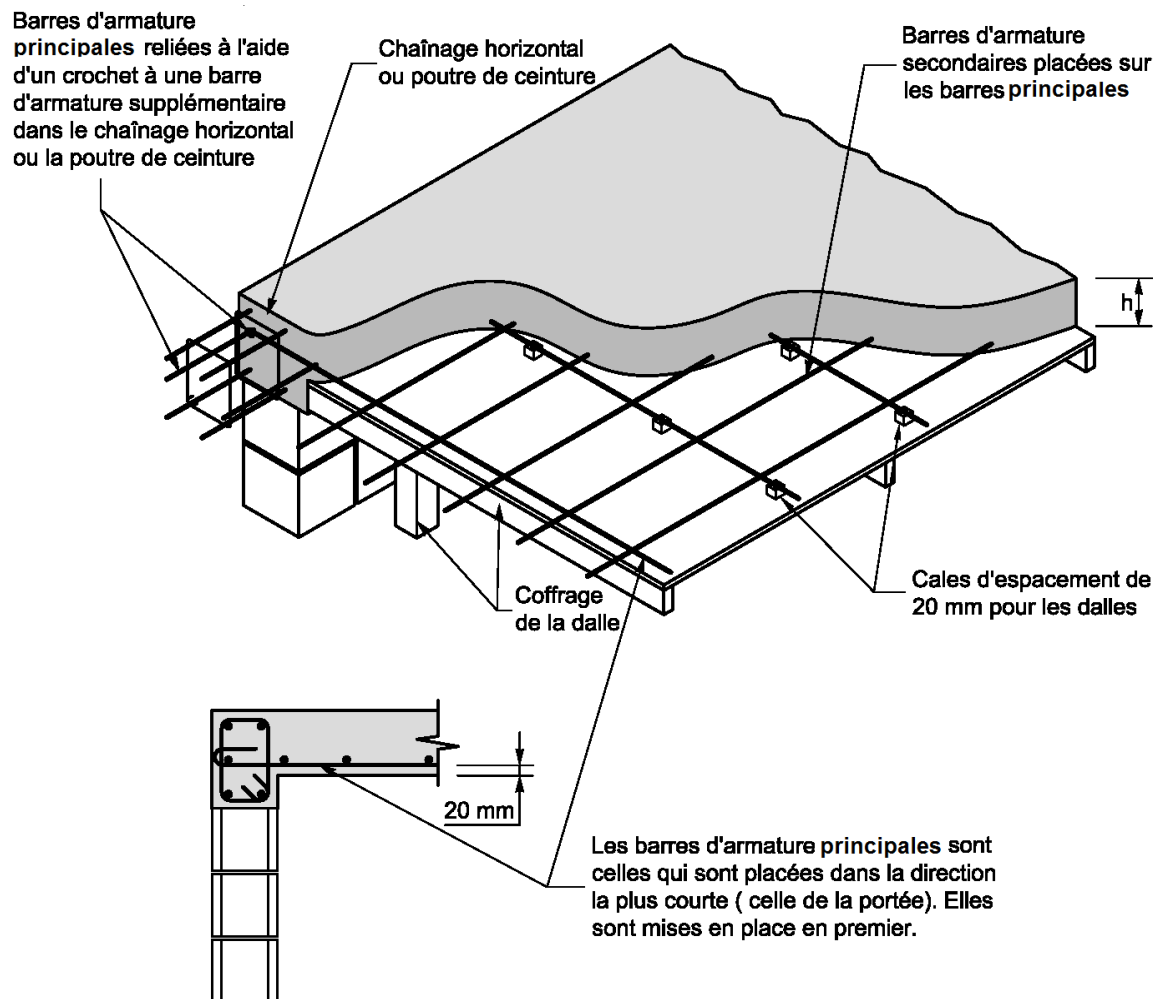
Armature d'une dalle de portée simple
